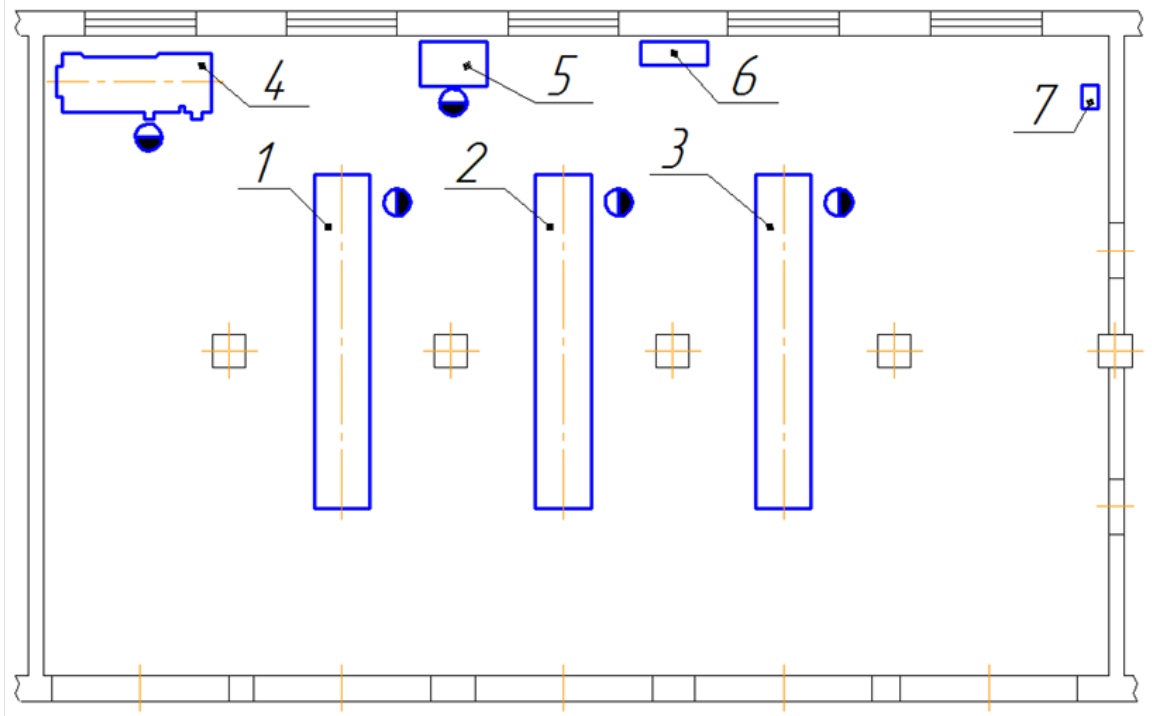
Схема дільниці технічного обслуговування і ремонту автомобілів: 1; 2; 3 – яма оглядова, 4 – верстат токарний; 5 – верстак слюсарний, шафа для інструментів; 6 – гідравлічний прес; 7 – верстат точильний.
